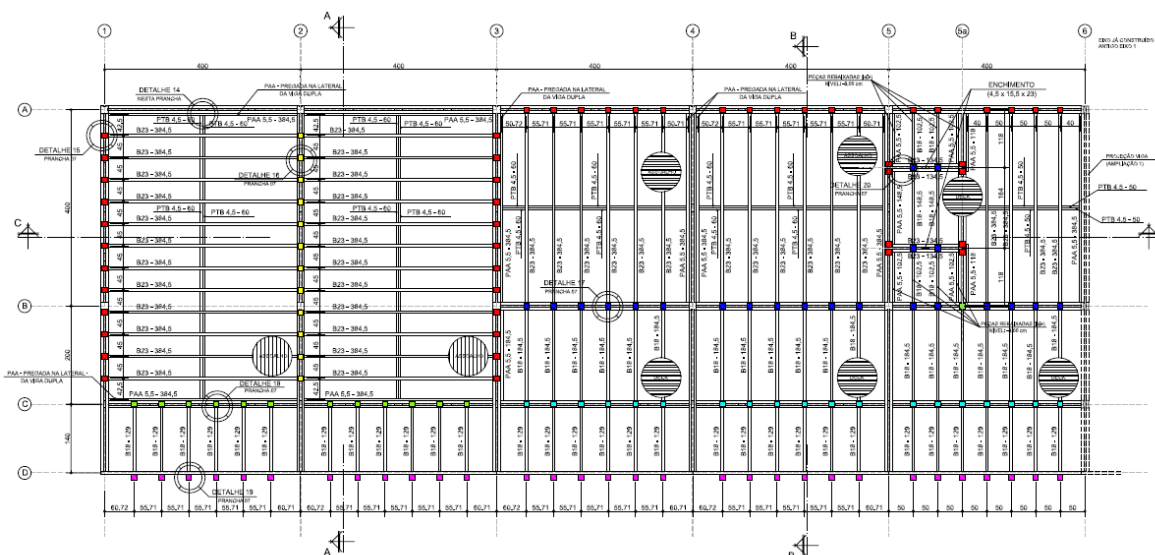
IMAFLORA II - Planta de barroteamento de piso. Fonte: Elaborada pelos autores.
